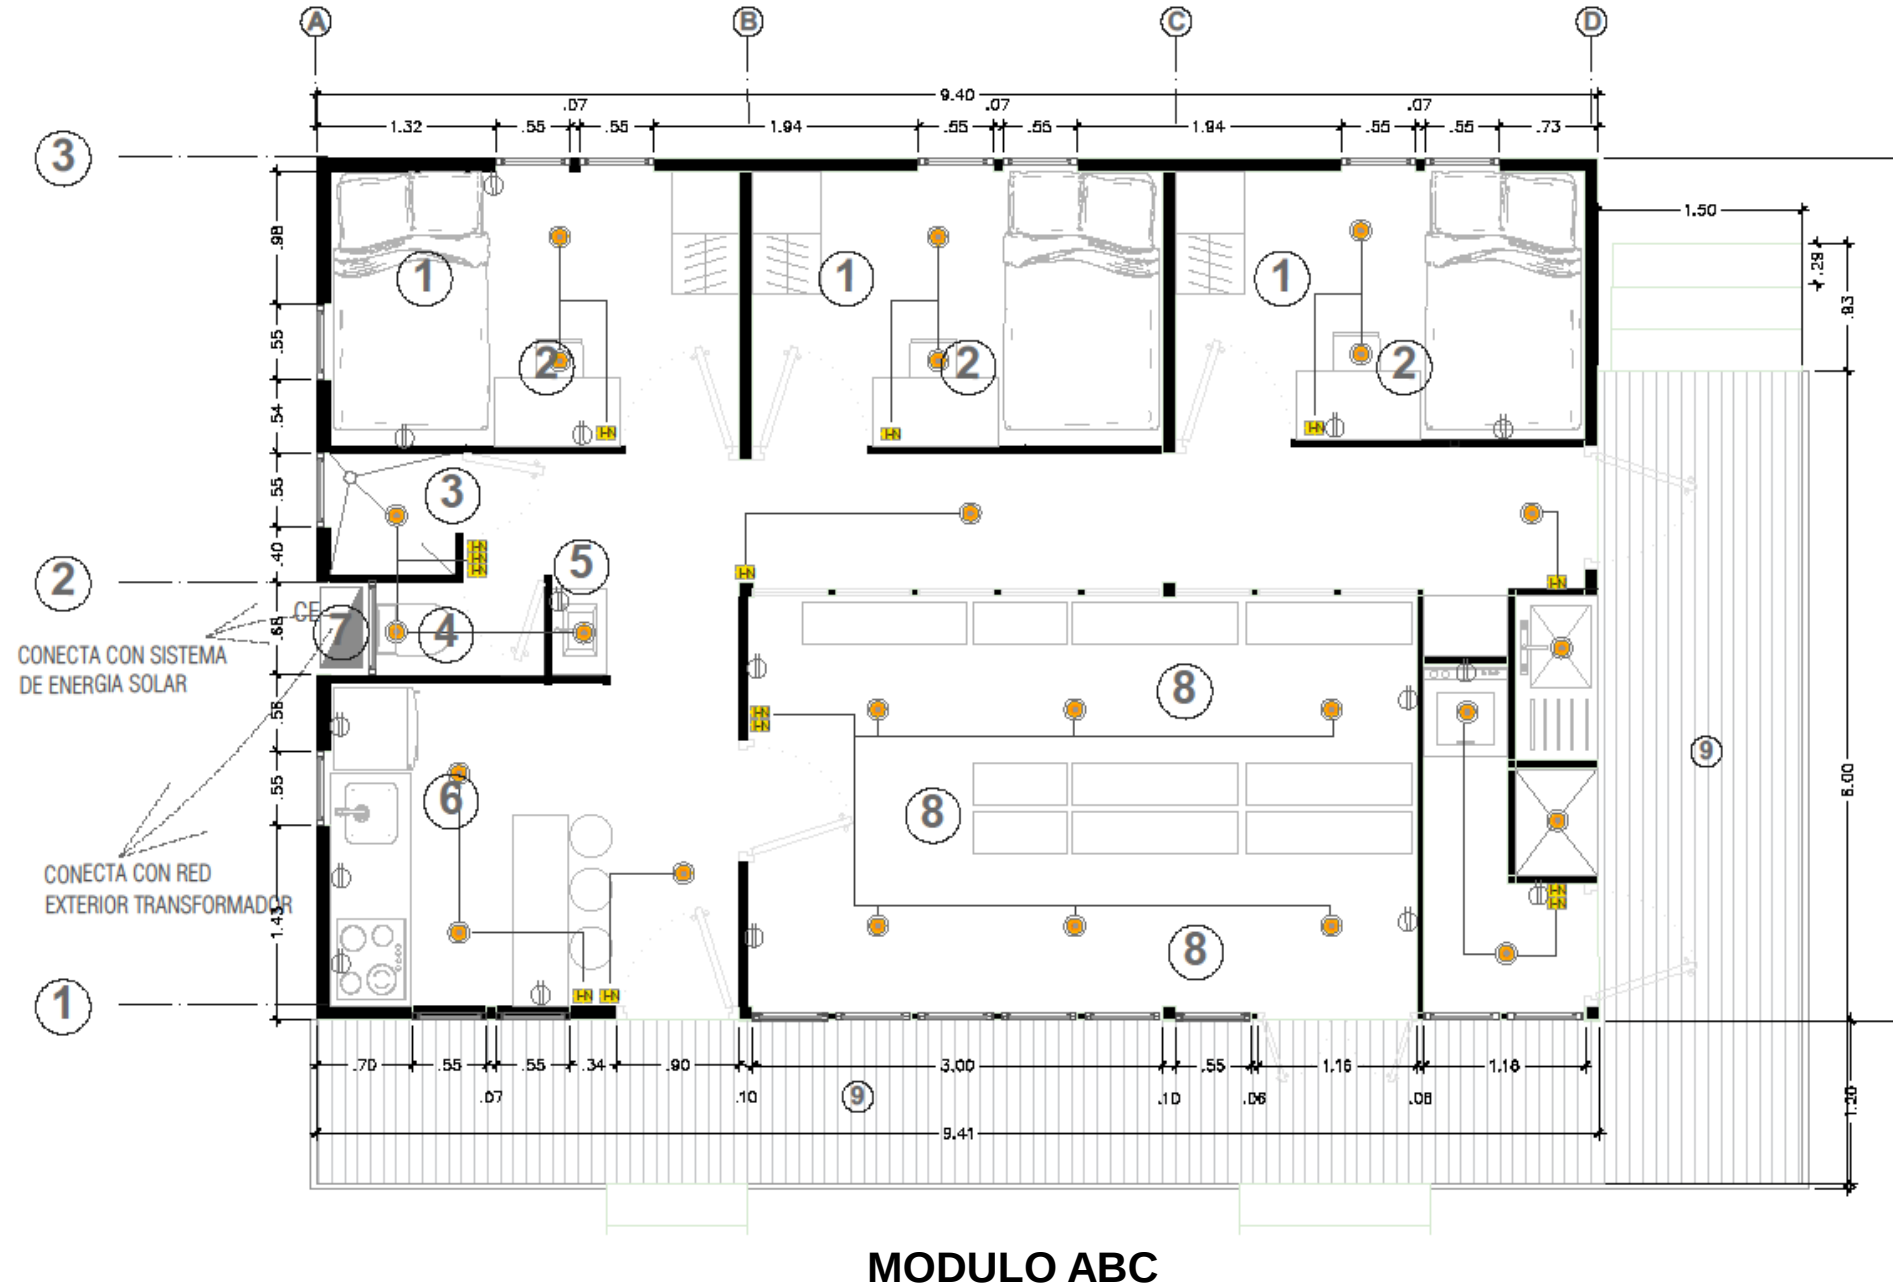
Planimetría módulo A,AB, John Fredy Jaramillo
